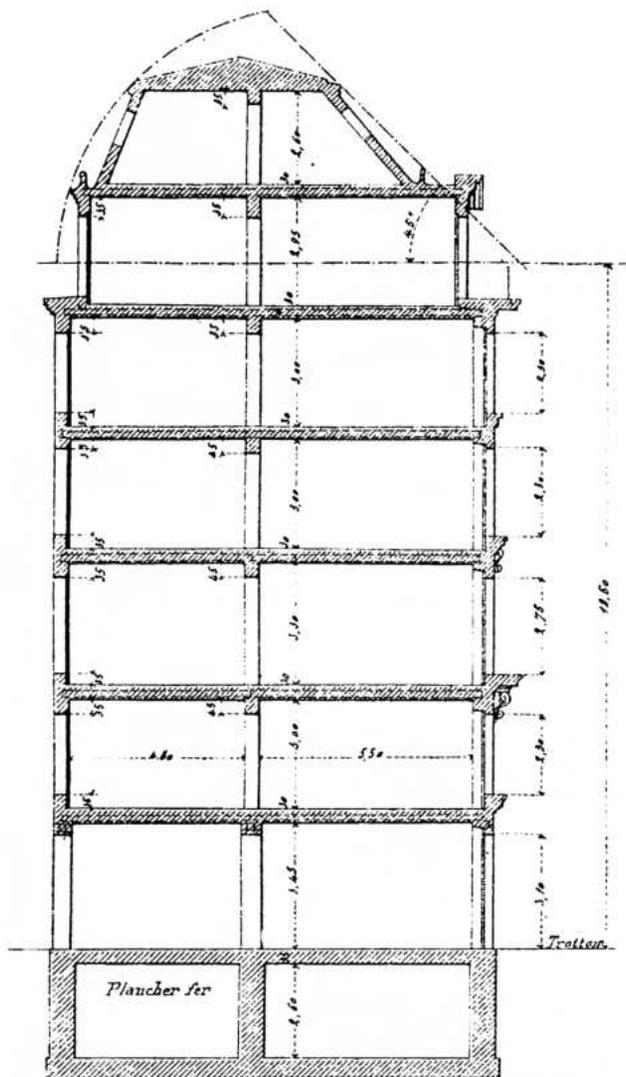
Coupe transversale sur un bâtiment construit sur le gabarit de 17,55 m (premier tiers du XIX^e siècle)
